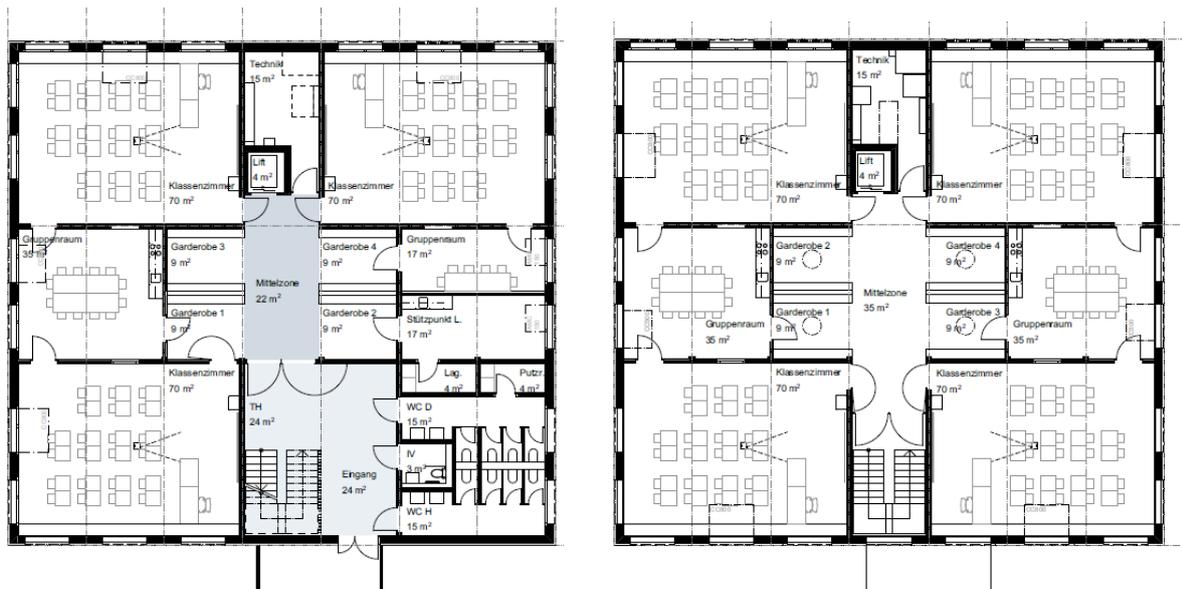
Grundrisse Erdgeschoss und Obergeschoss Typ «Luzerner Modul Carré»⁸
